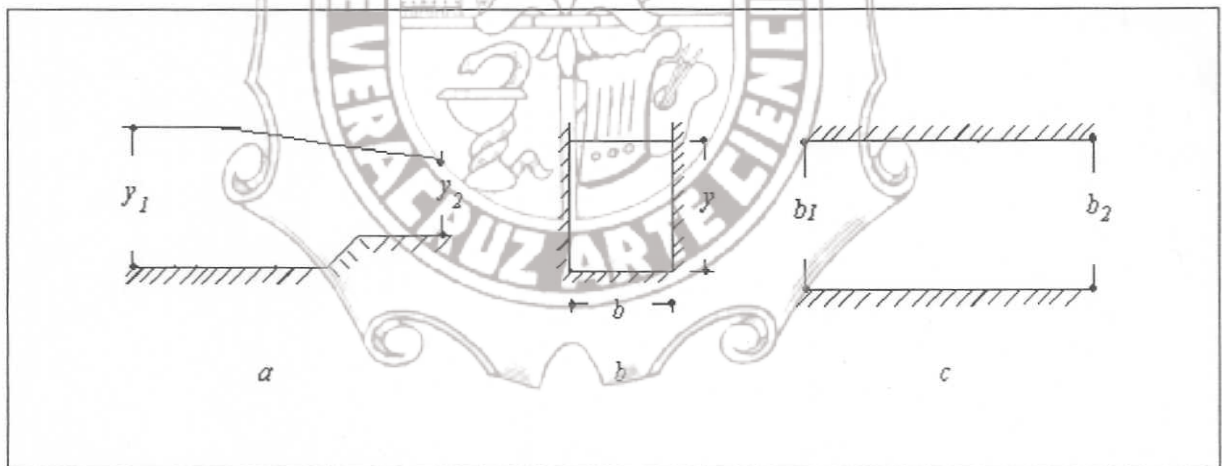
a) Perfil, b) Sección rectangular c) Planta del canal
